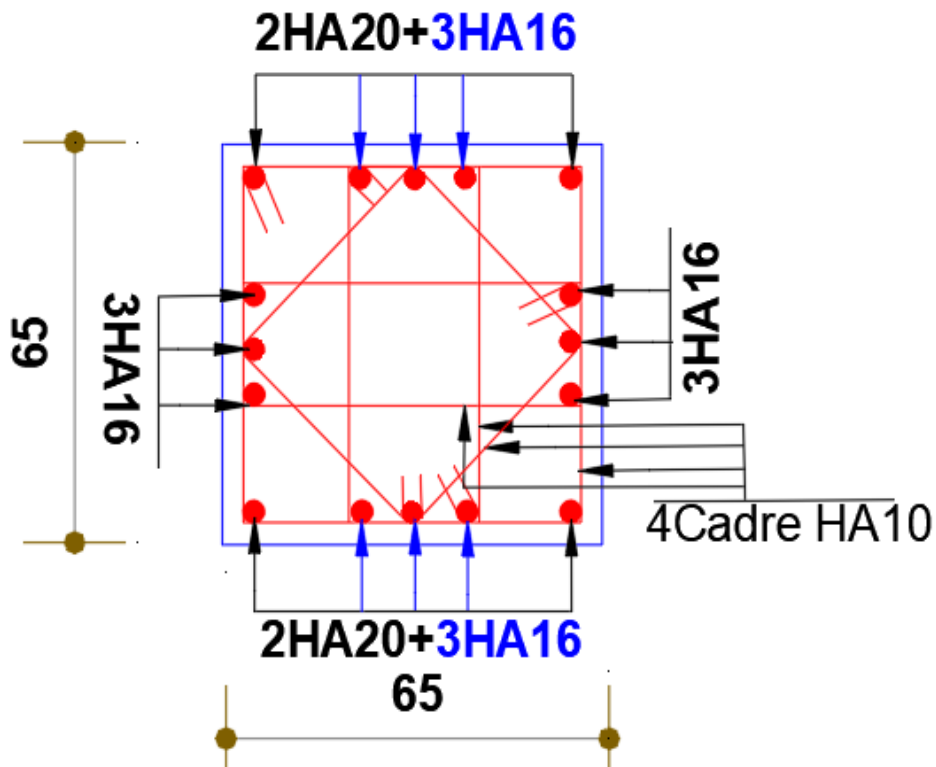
Ferrailage du poteau du sous-sol (C15)
